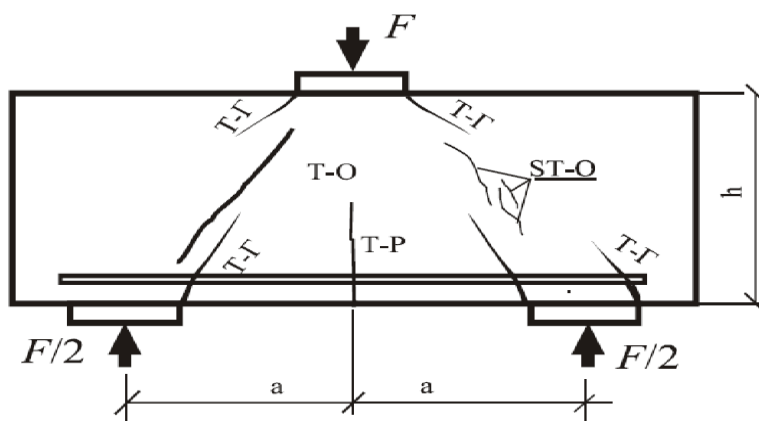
Классификация трещин в железобетонных балках
